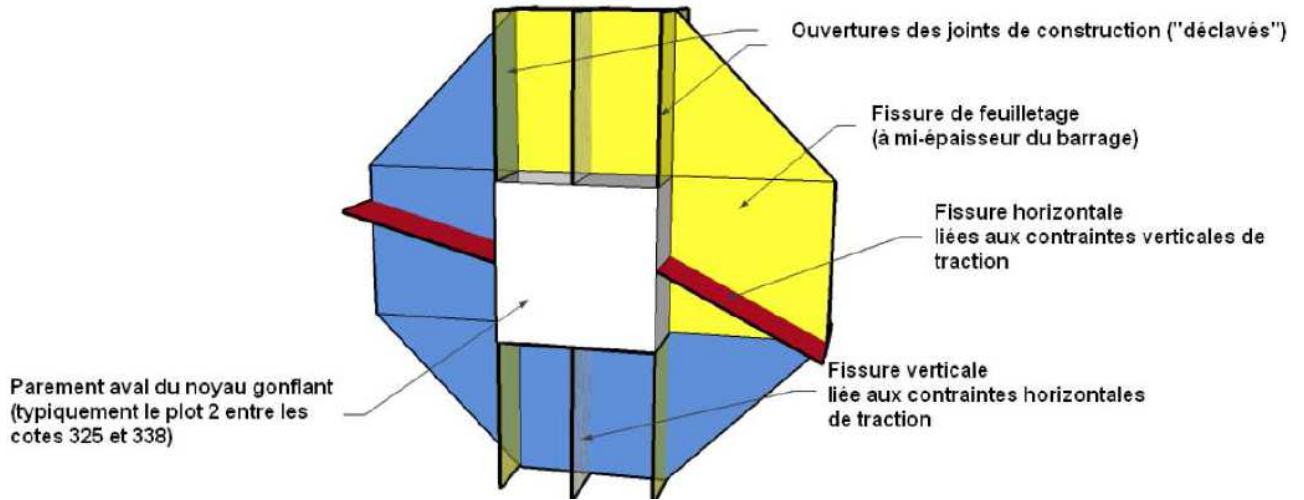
Schéma des plans de fissuration autour d'une zone gonflante
